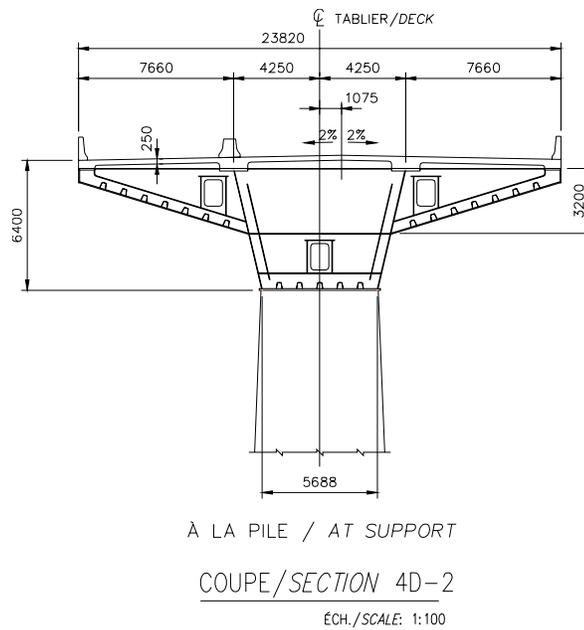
Coupe transversale – Pont en ossature mixte avec des piles en V – monocaissin fermé
